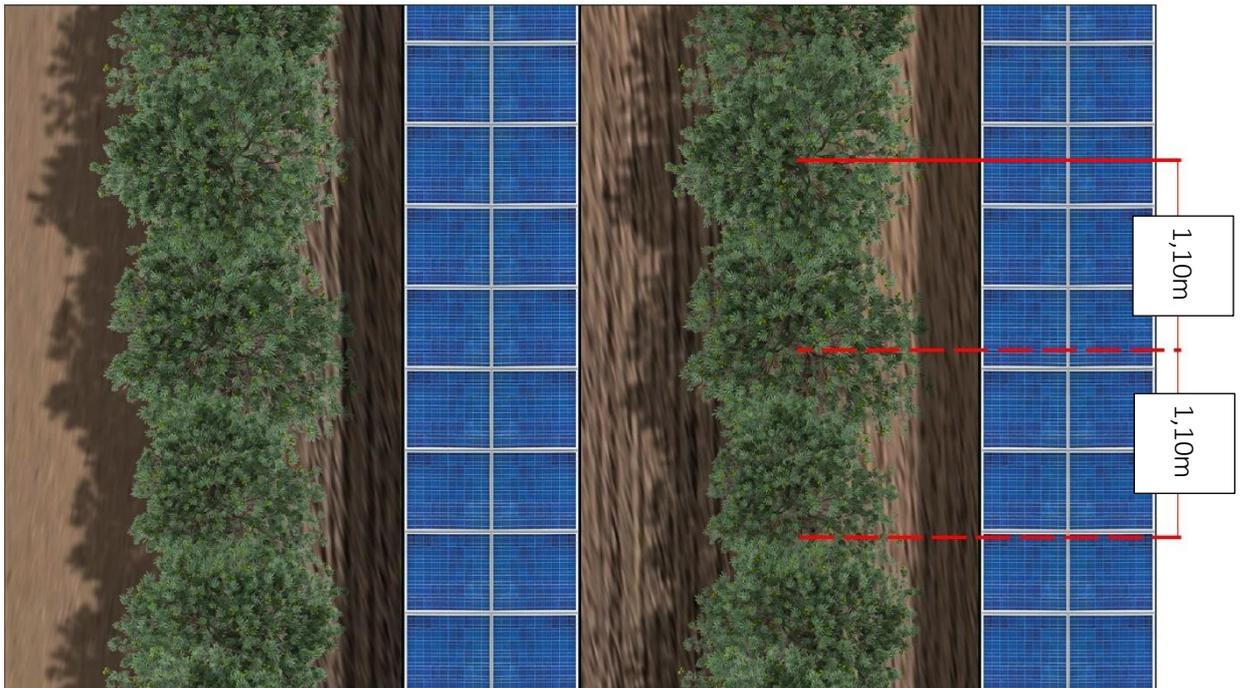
Tipologico – Vista Planimetrica dell’impianto Olivicolo.
